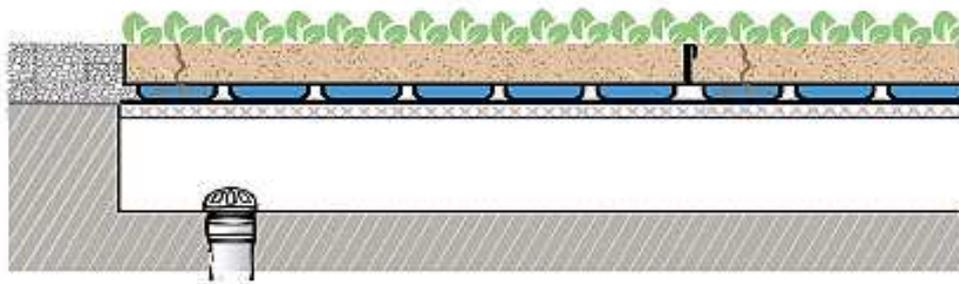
Ralo abacaxi sob o teto verde modular apoiado em gradil metálico fixado à vigas invertidas
